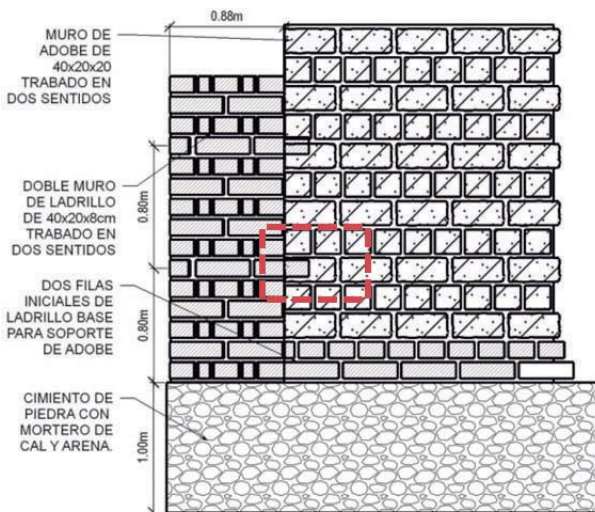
Sección y detalle de unión de muro de ladrillo con muro de adobe.
